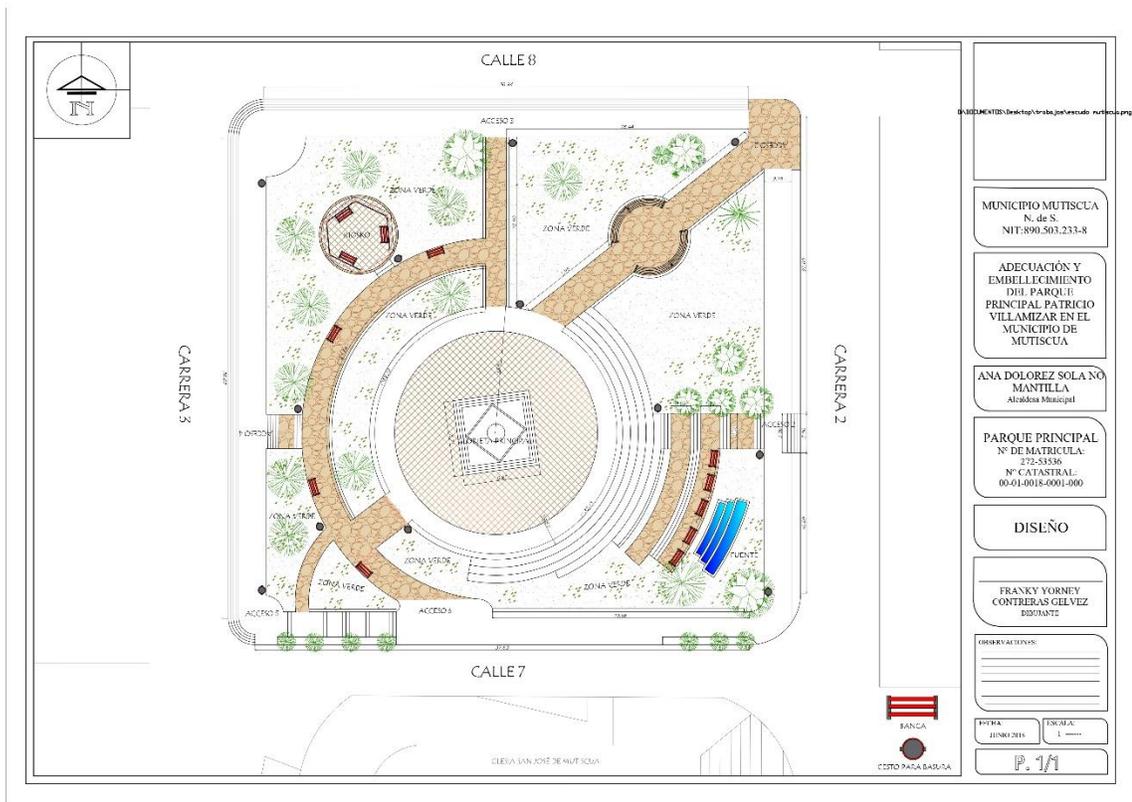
Diseño planta arquitectónico parque de Mutiscua, escala 1:600.
